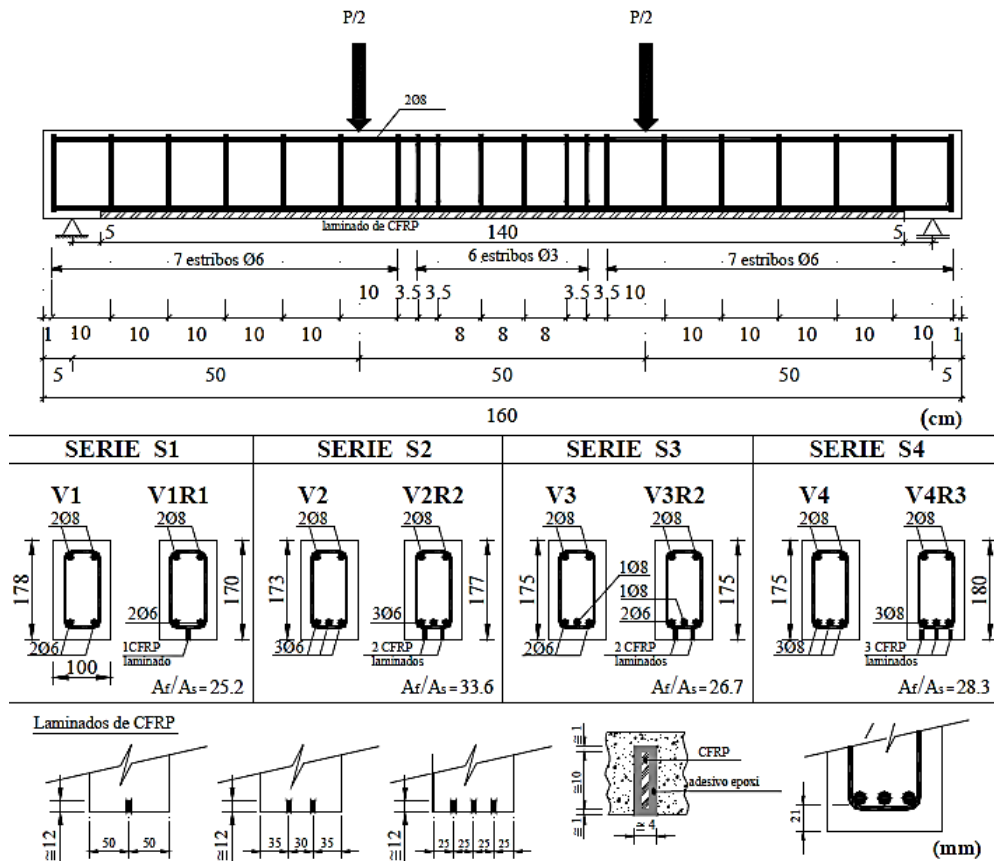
Configuração e detalhes das vigas ensaiadas por Barros e Fortes (2005).
